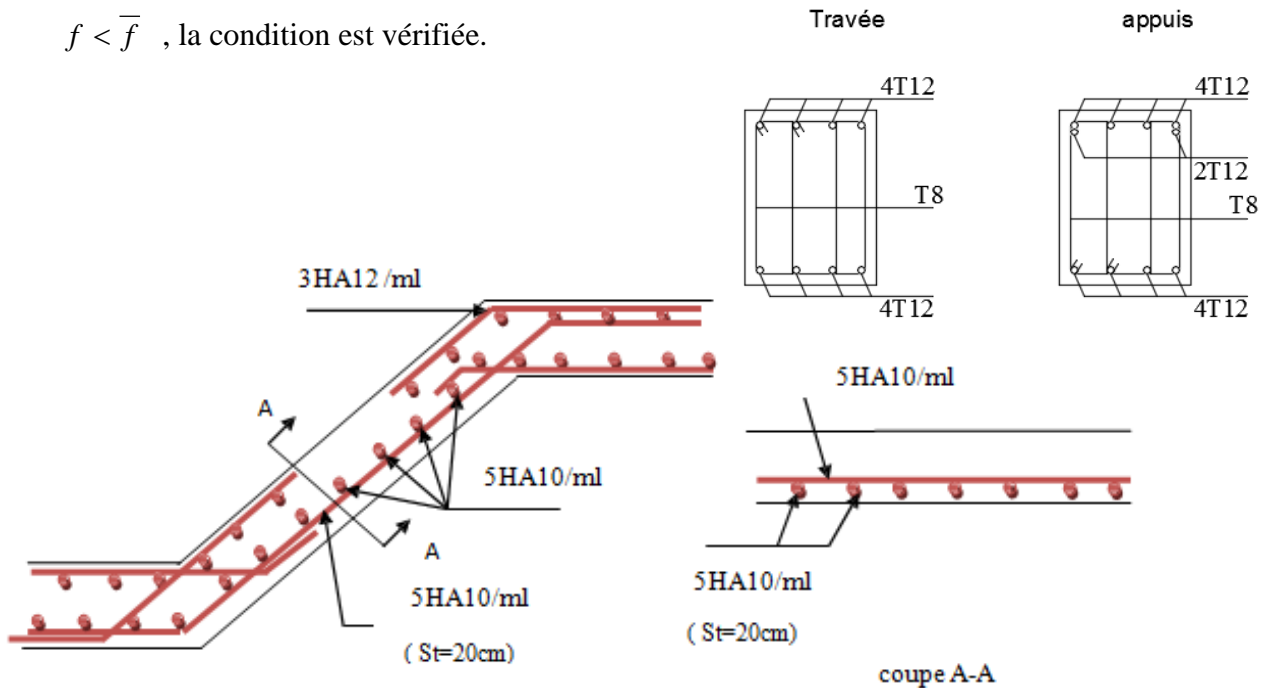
Disposition constructive des armatures des Escaliers à trois volées.
